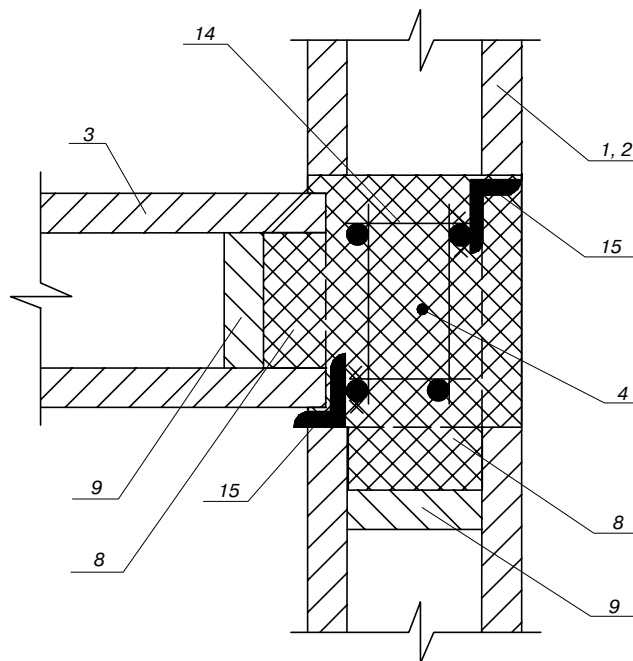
Вариант опирания плиты перекрытия в зоне стенового проема на жесткий арматурный каркас
